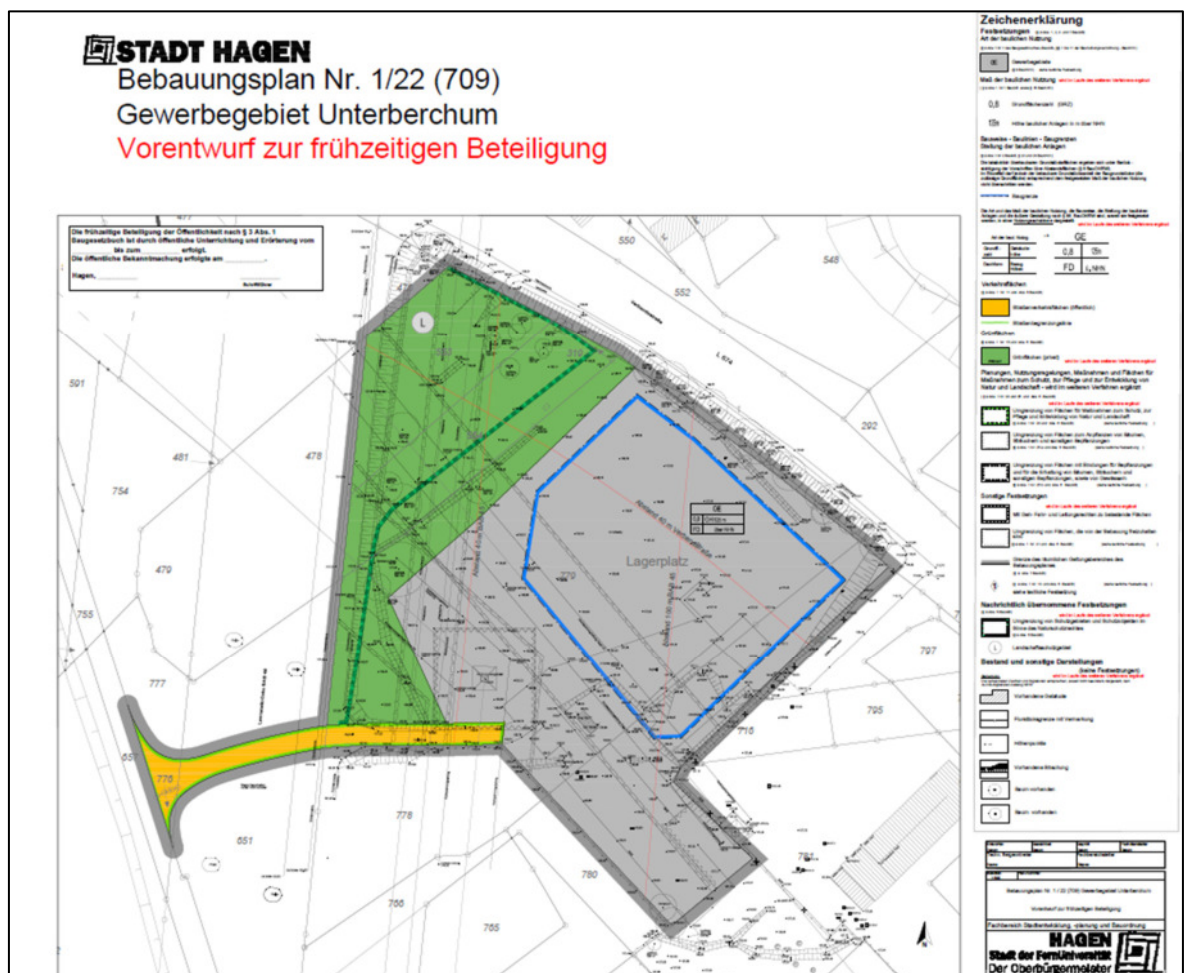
Bebauungsplan Nr. 1/22 (709) „Gewerbegebiet Unterberchum“ [1]
